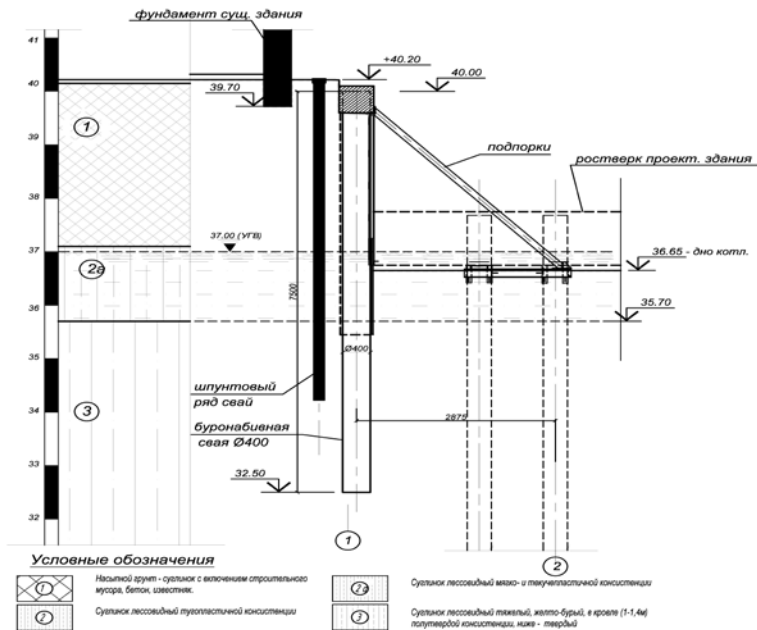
Схема шпунтового ограждения при строительстве жилого дома по ул. Осипова, 40
